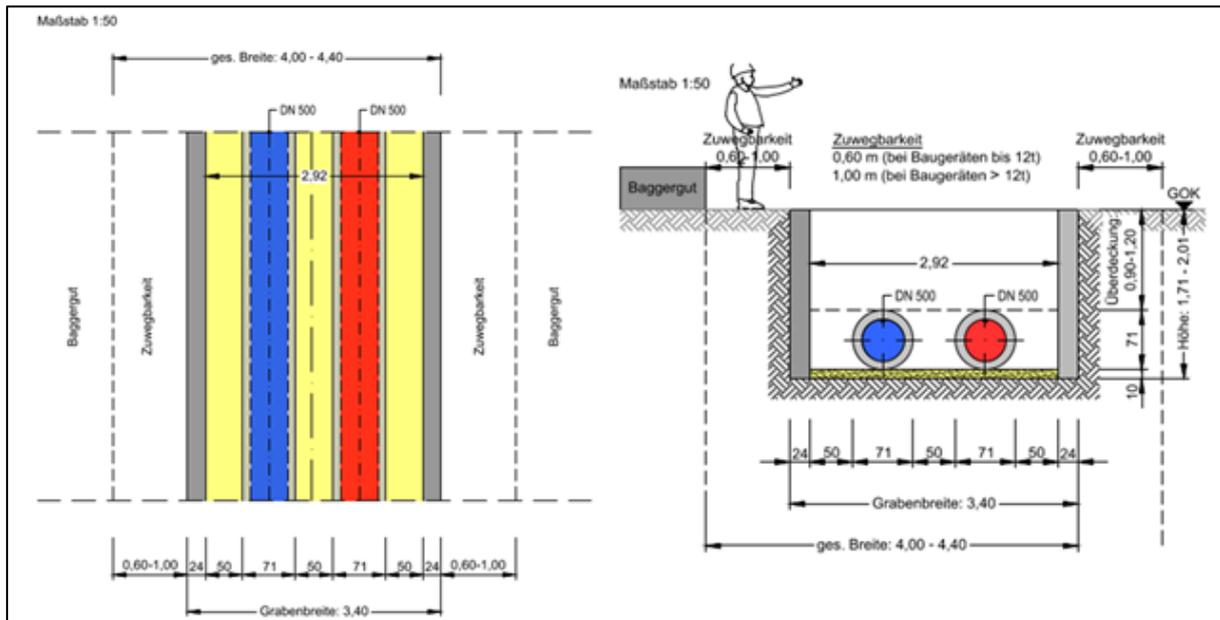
Dimensionierung des Standardbaugrabens (Draufsicht und Querschnitt)
